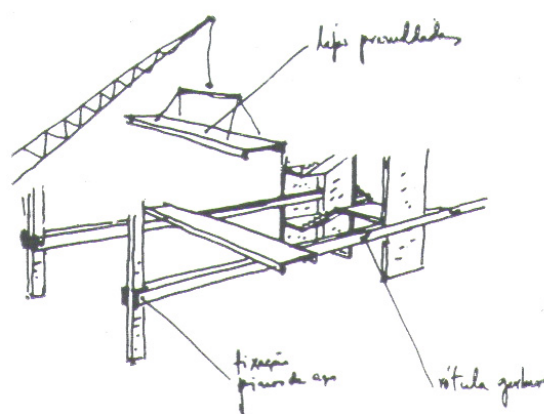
Construção, colocação de uma laje pré-fabricada.
